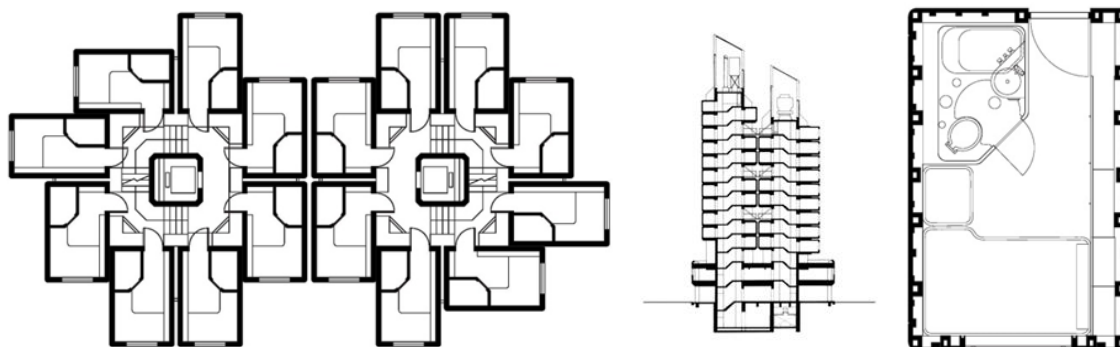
Nakagin Capsule Tower*, 1972. Planta-tipo, secção do edifício e *layout* genérico da cápsula.
